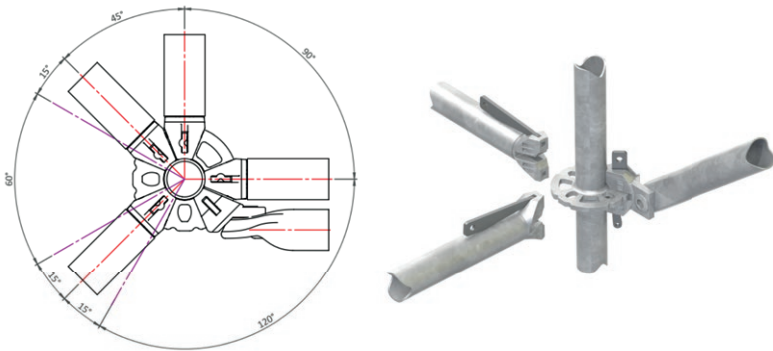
Grundriss RINGSCAFF-Knoten
